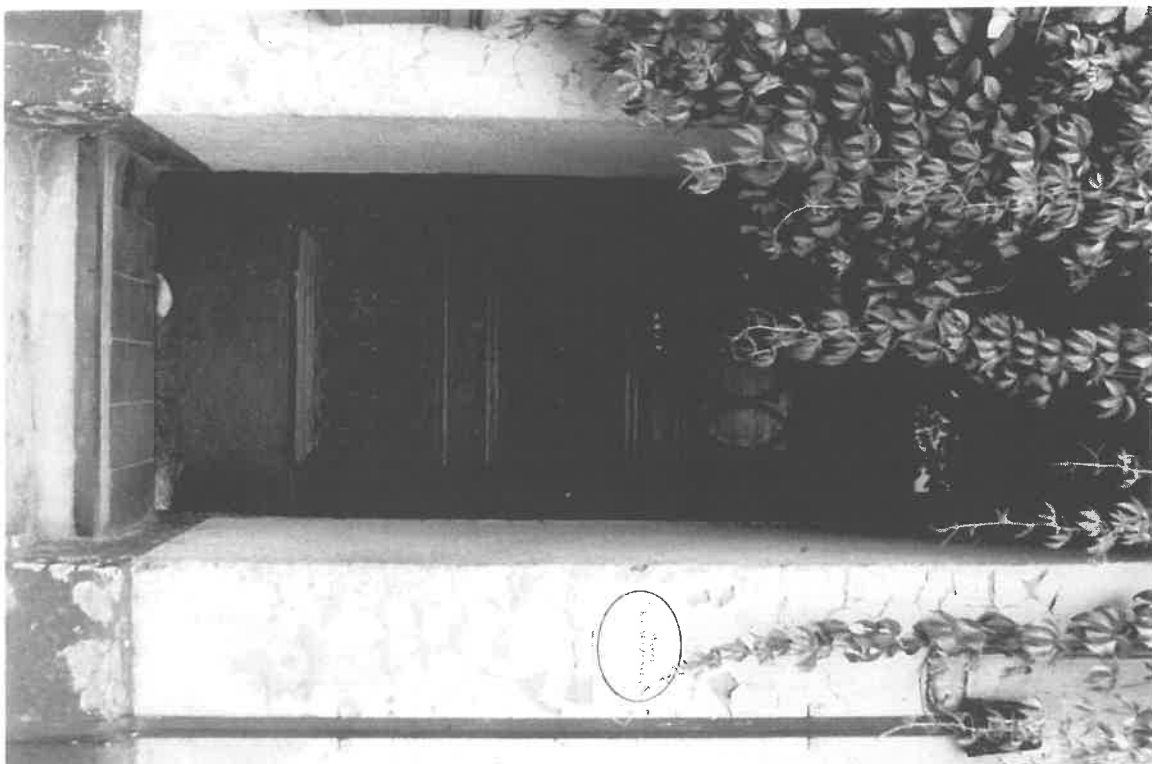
/10. Kamienica Rynek 1, elewacja południowa - narożnik południowo-wschodni elewacji (widok od południa).
